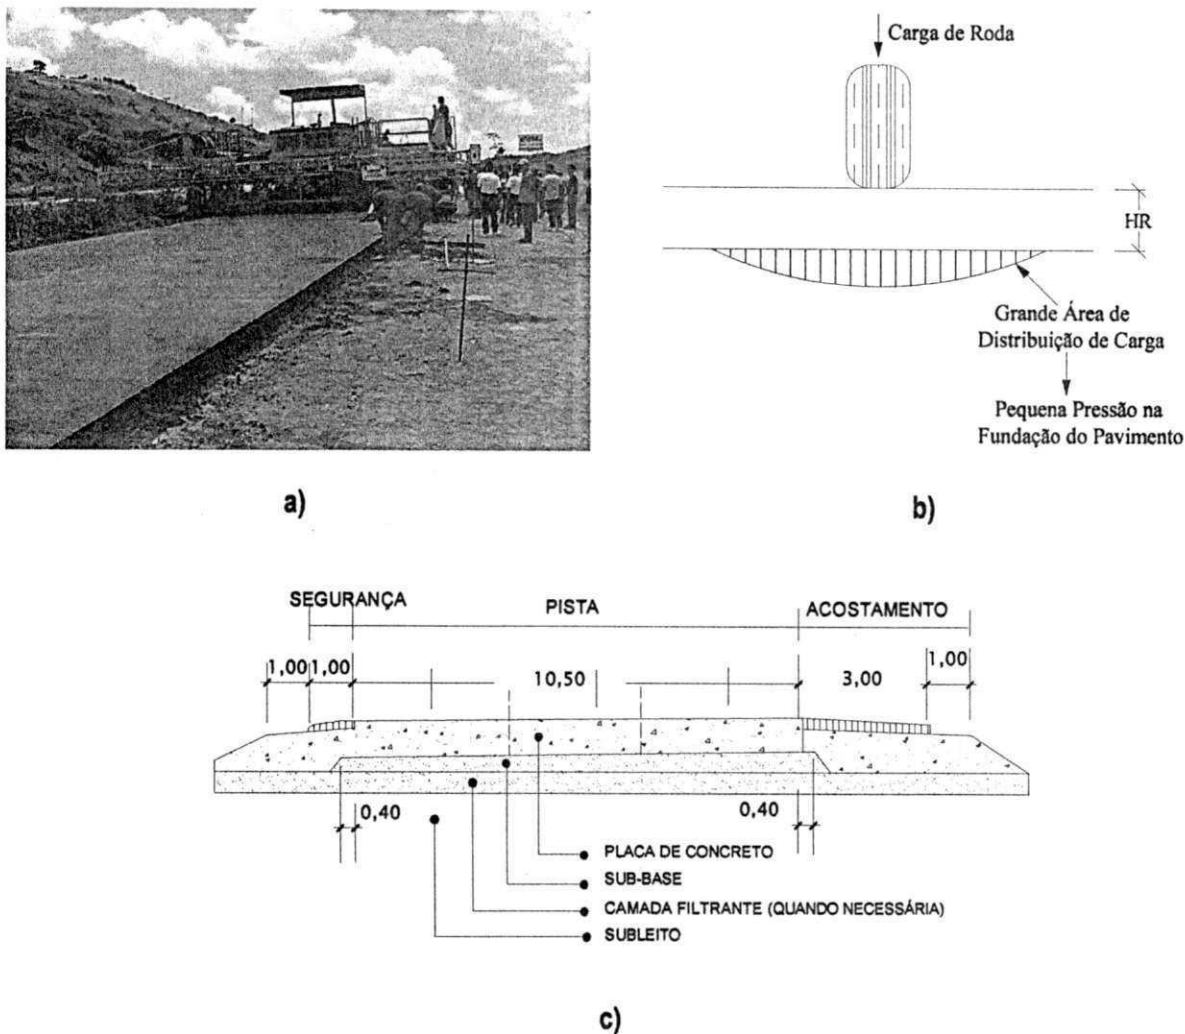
a) Superfície de um pavimento rígido; b) Distribuição de carga na fundação do pavimento rígido e c) Estrutura de um pavimento rígido
